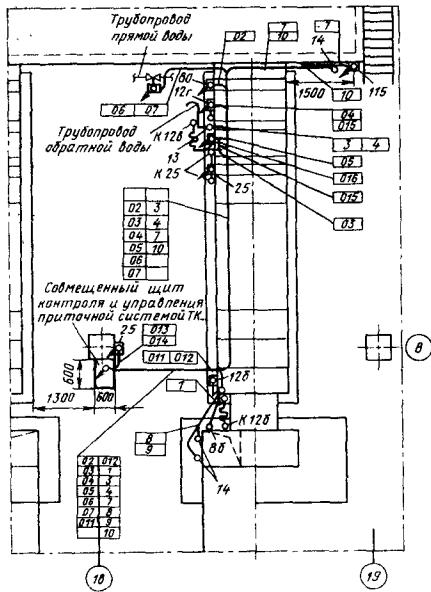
Фрагмент монтажного чертежа электрических и трубных проводок вентиляционной камеры
